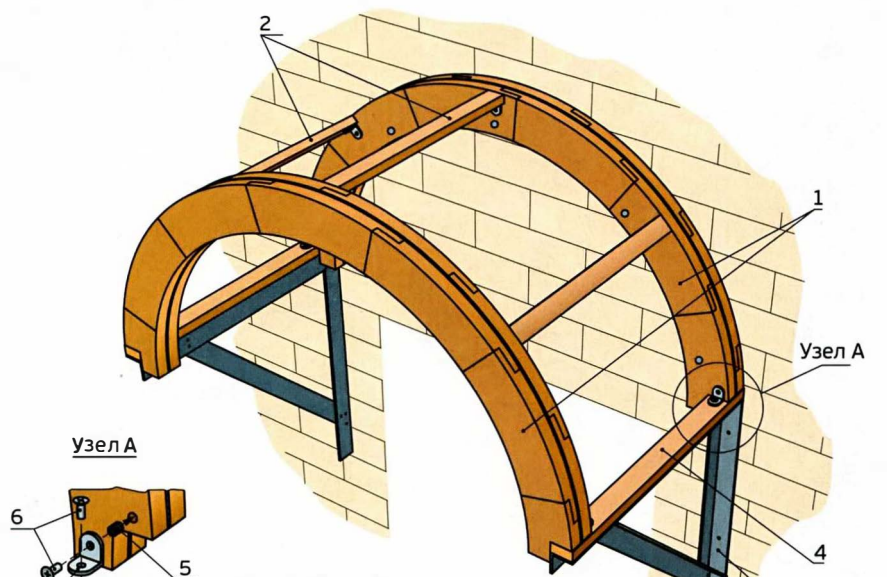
Козырёк из дерева и металла: 1 — полуколёцо, собранное из секторов; 2 — распорка; 3 — кронштейн; 4 — деревянный брусок; 5 — резьбовая втулка; 6 — винт; 7 — уголок.
